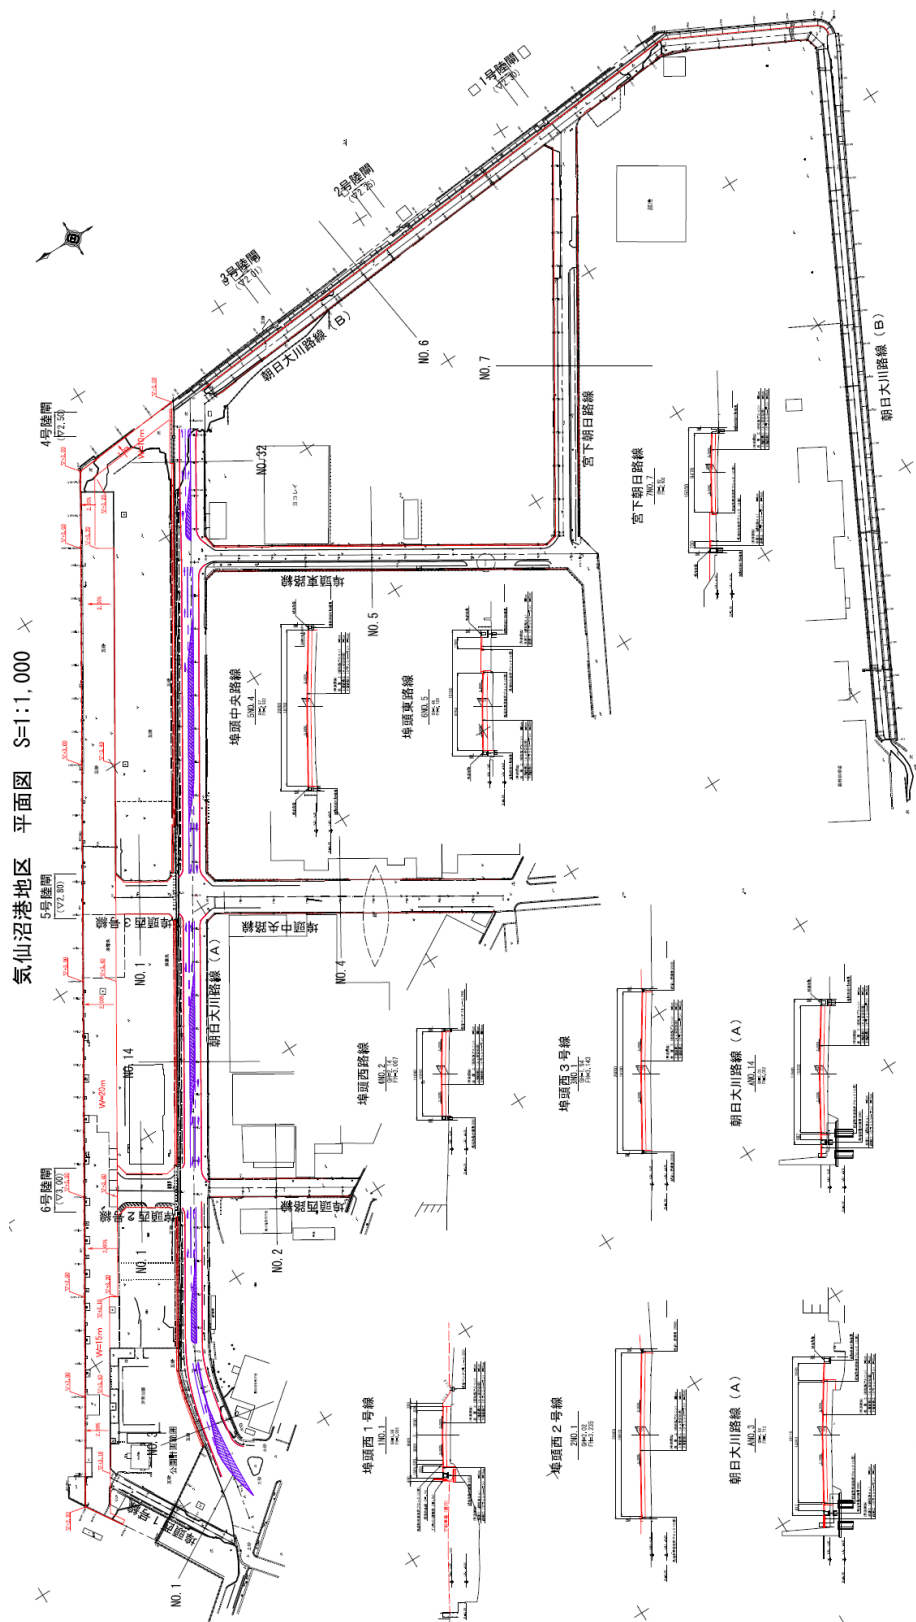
No.6 埠頭中央路線平面図 (復旧後)
